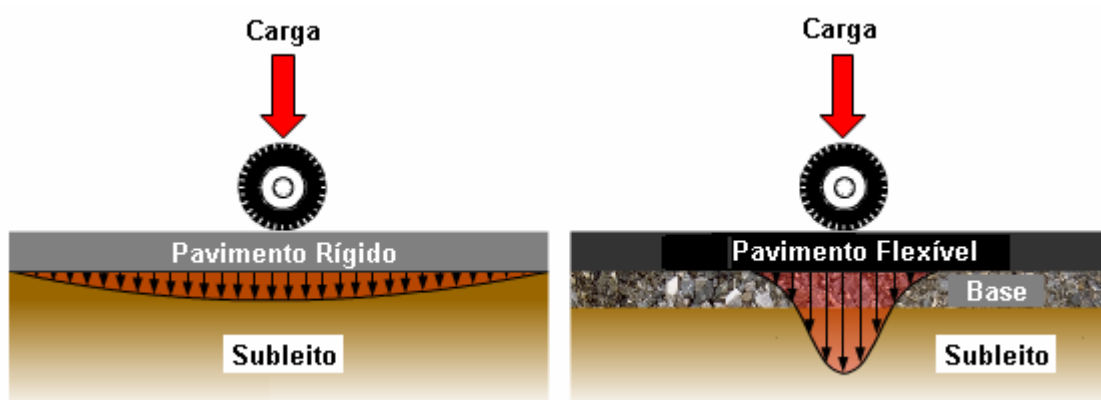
Distribuição de cargas nos pavimentos rígido e flexível
